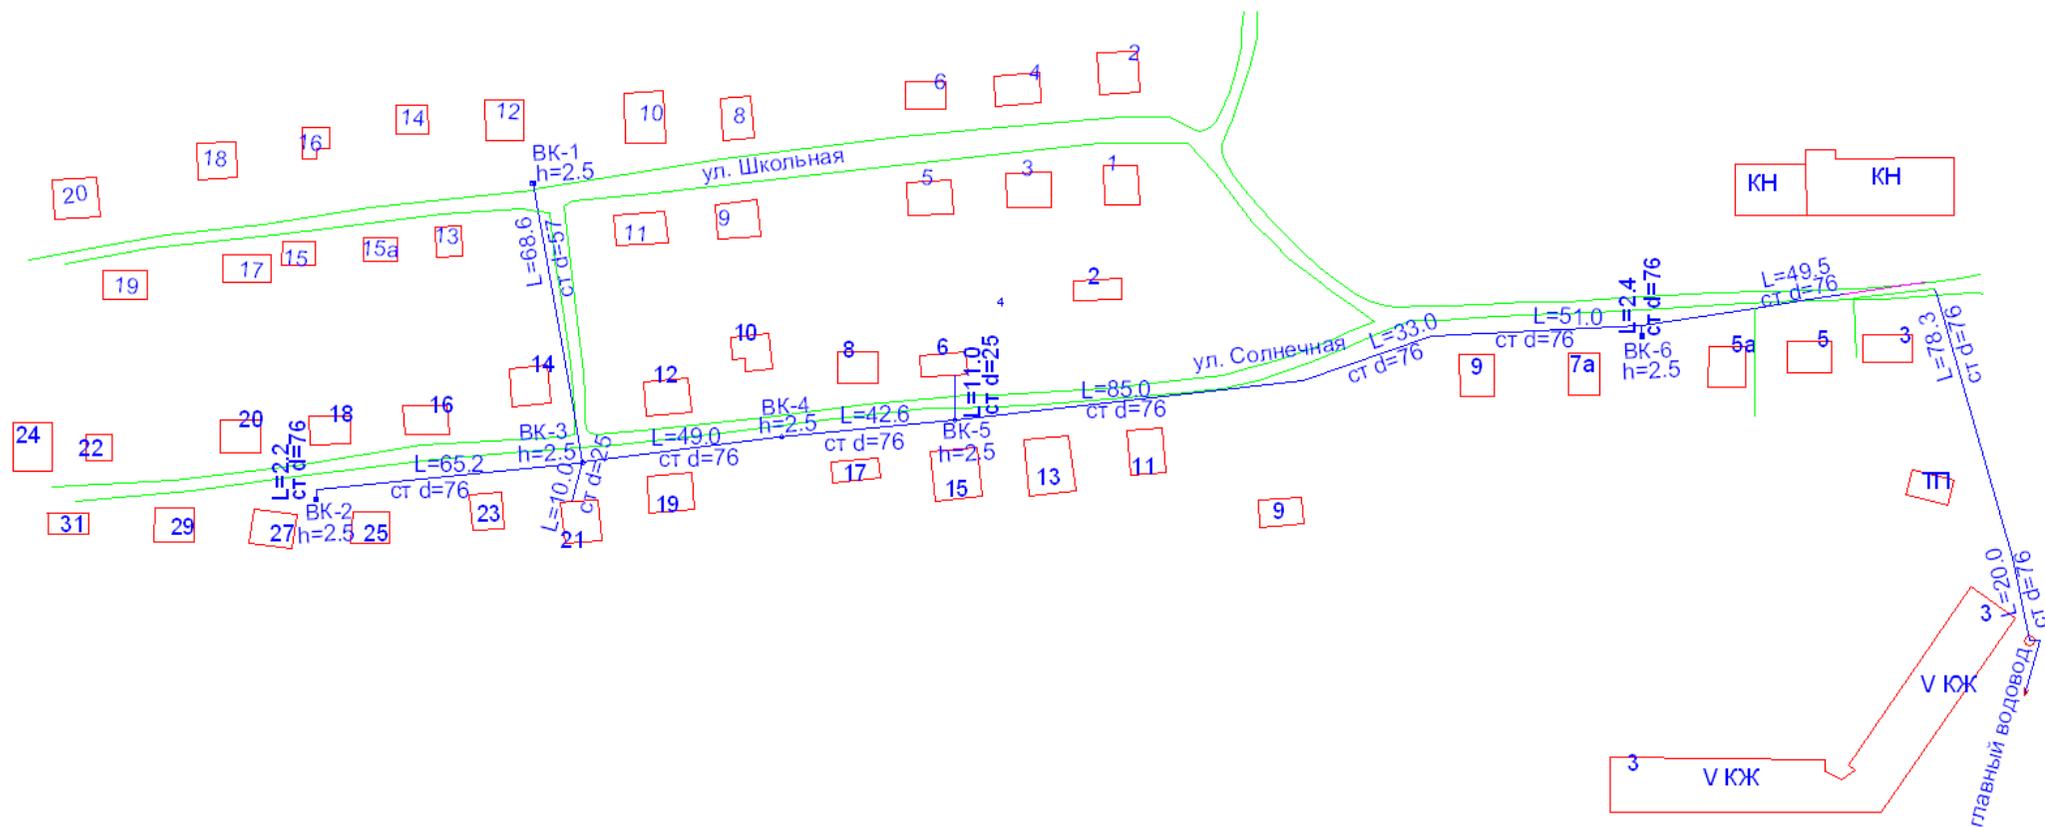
План водопроводных сетей от ул. Железнодорожной, 3 до ул. Солнечной, 27 и от ул. Солнечной, 21 до ул. Школьной, 12 г. Дальнегорска
